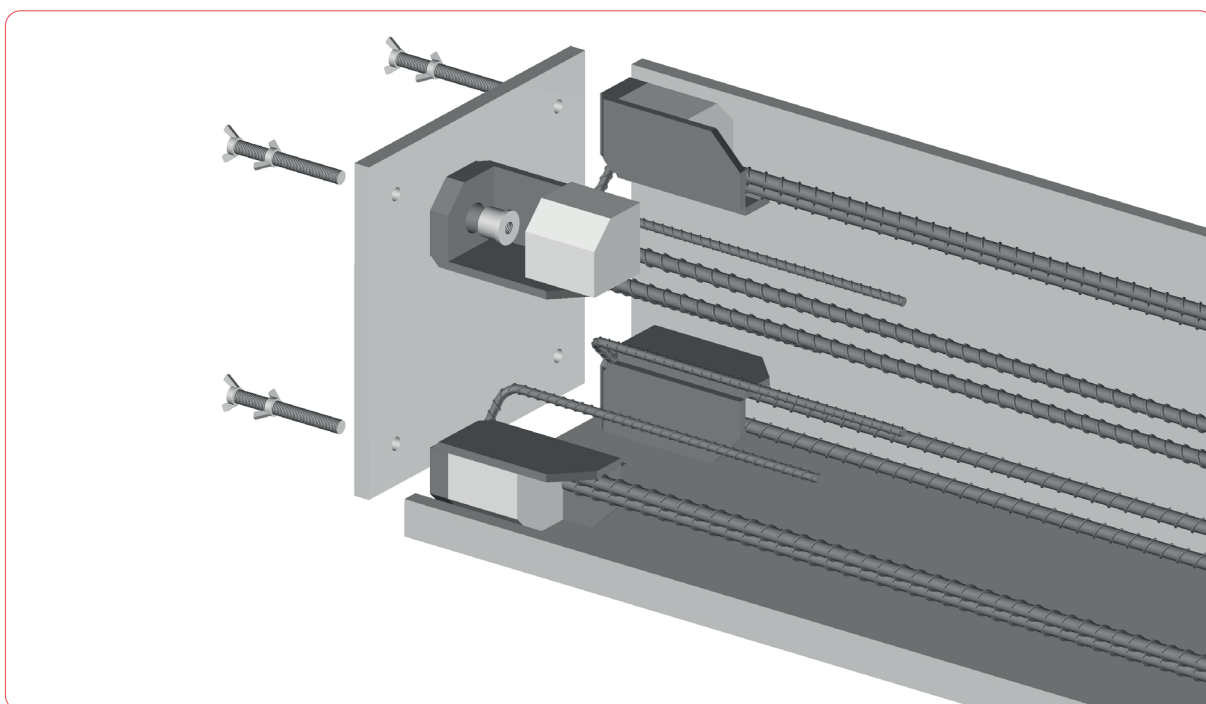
Detalle de montaje de pies de pilar en encofrado
